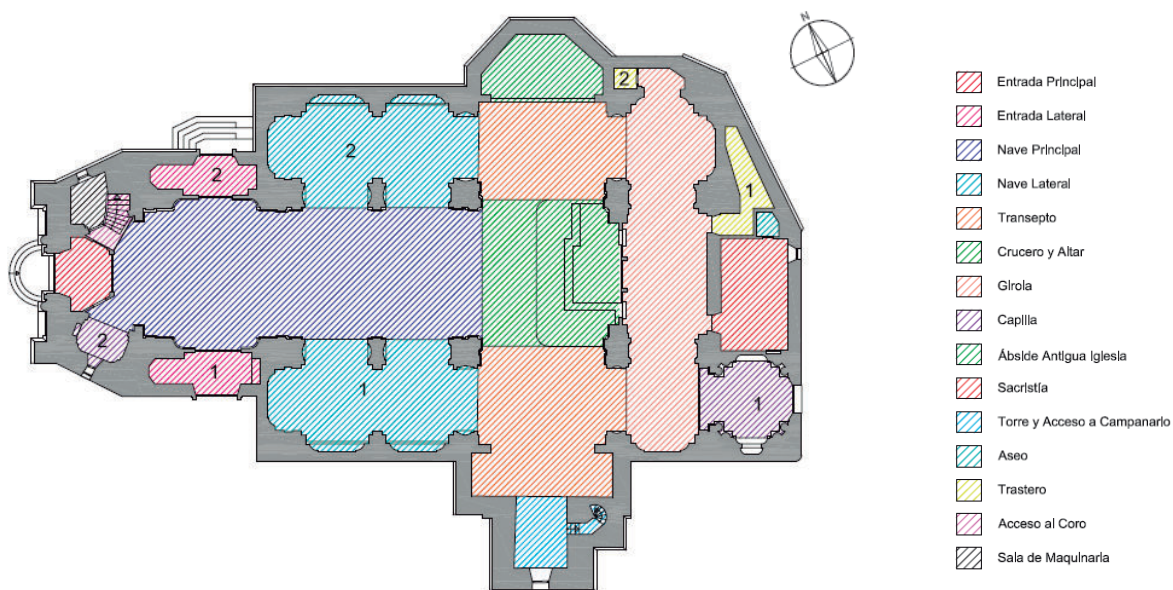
Plano de planta con indicación de usos (P-7). 2014. M^aNieves Pujol
